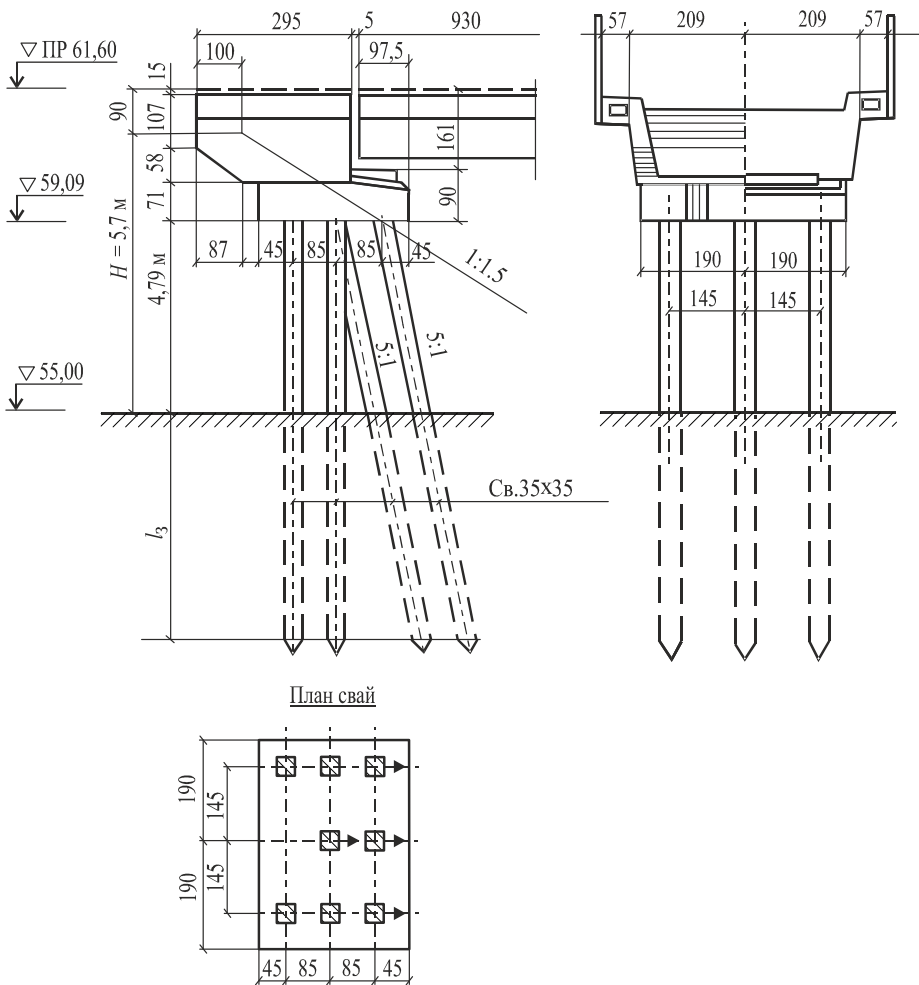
Свайный устой для мостов эстакадного типа под железобетонные пролетные строения с ездой поверху по типовому проекту № 708/11, ЛГТМ–1974 г.
